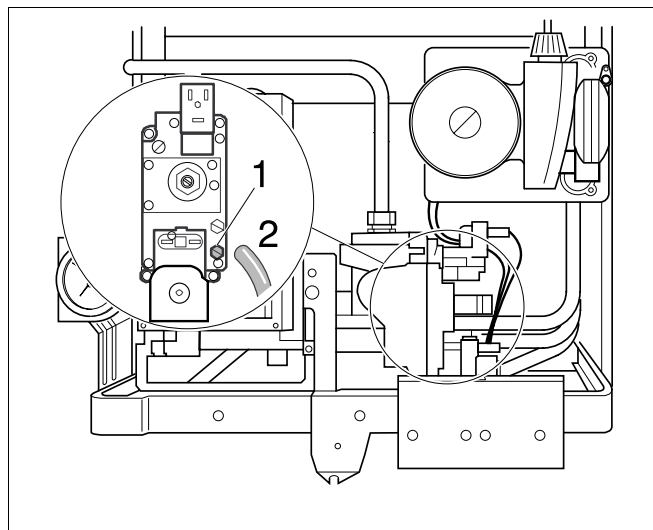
Misurazione della pressione di collegamento del gas (apparecchiatura SIT)
